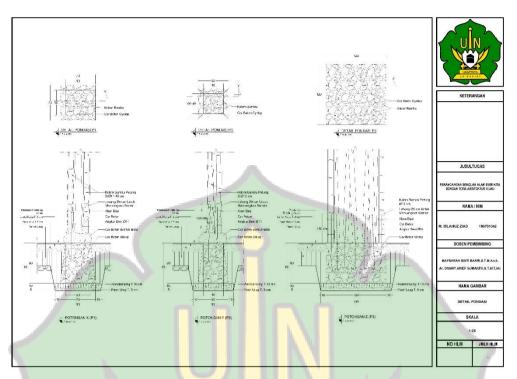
34 Denah pondasi tapak Sumber : Dokumen Pribadi
